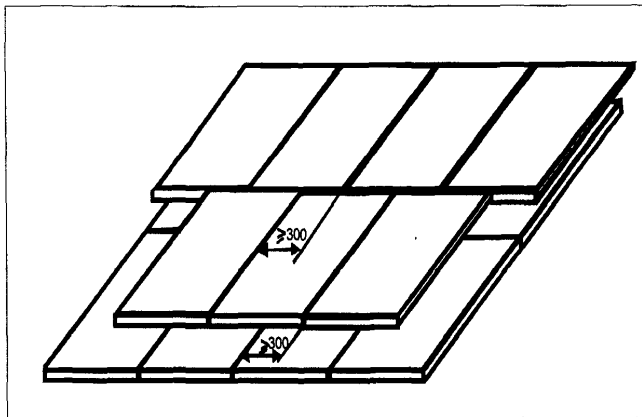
Схема укладки тепло-звукоизолирующих пенополистирольных плит
